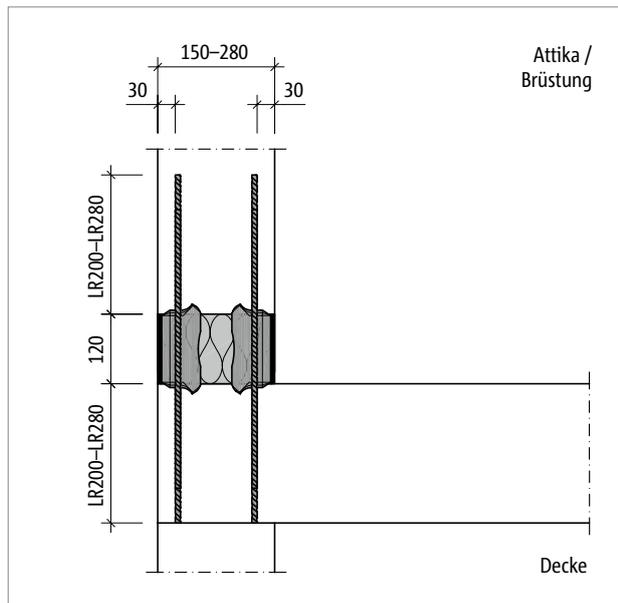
Schöck Isokorb® CXT Typ A-MM1-REI30: Produktschnitt
